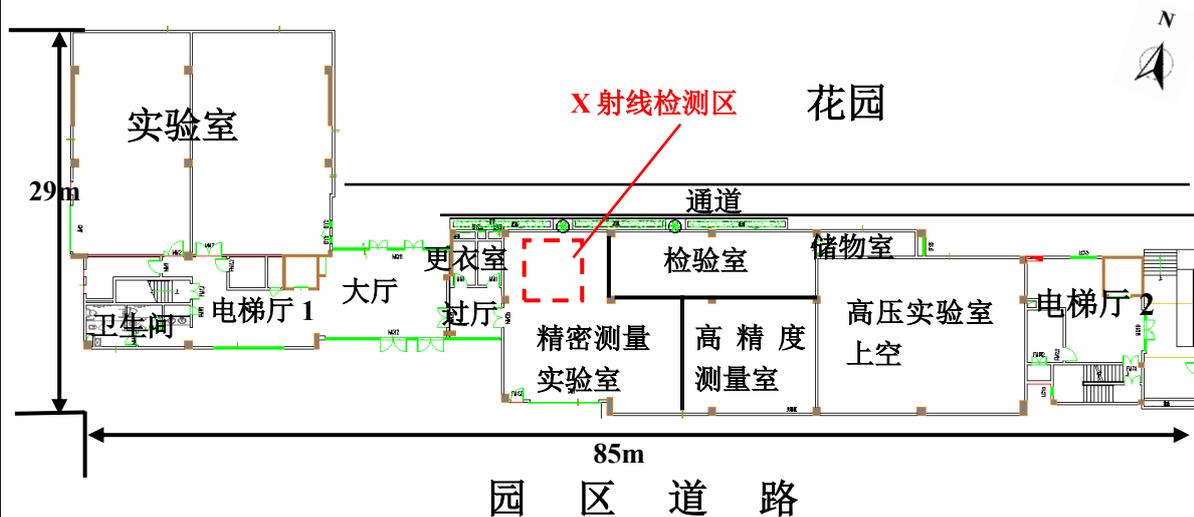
2 号楼和 3 号楼 1 层平面布置图
